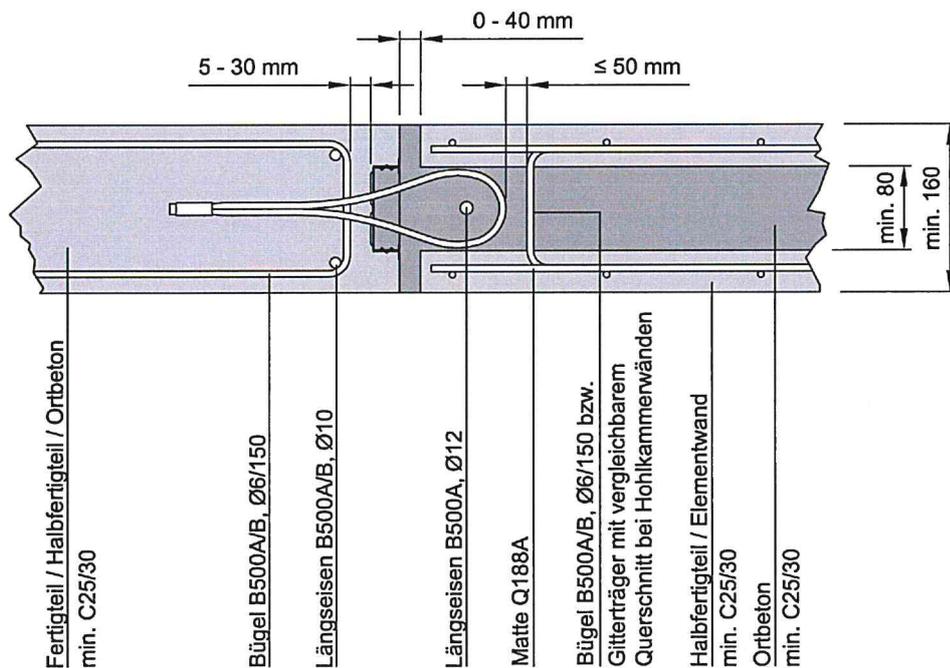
Regel-Querschnitt mit Halbfertigteil / Elementwand, Bewehrung
